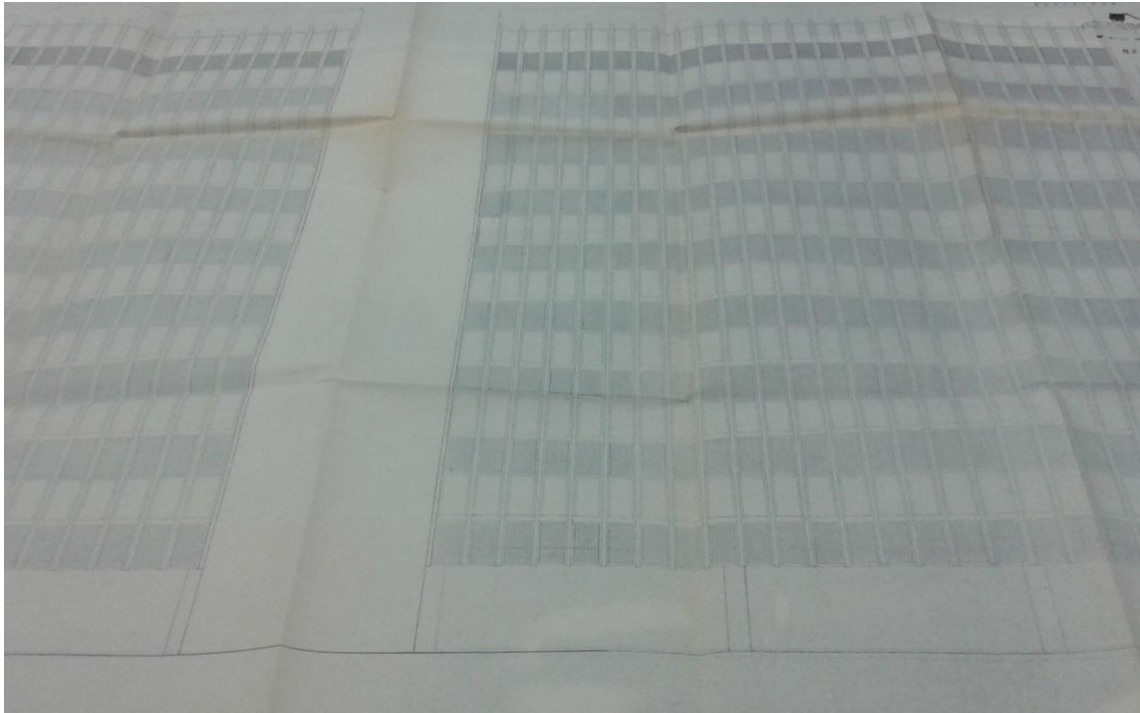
> Fachada de un edificio destinado a locales comerciales y aparcamiento en la avenida de la Catedral. Proyecto aprobado en 1975 (Fuente: ibíd.).
